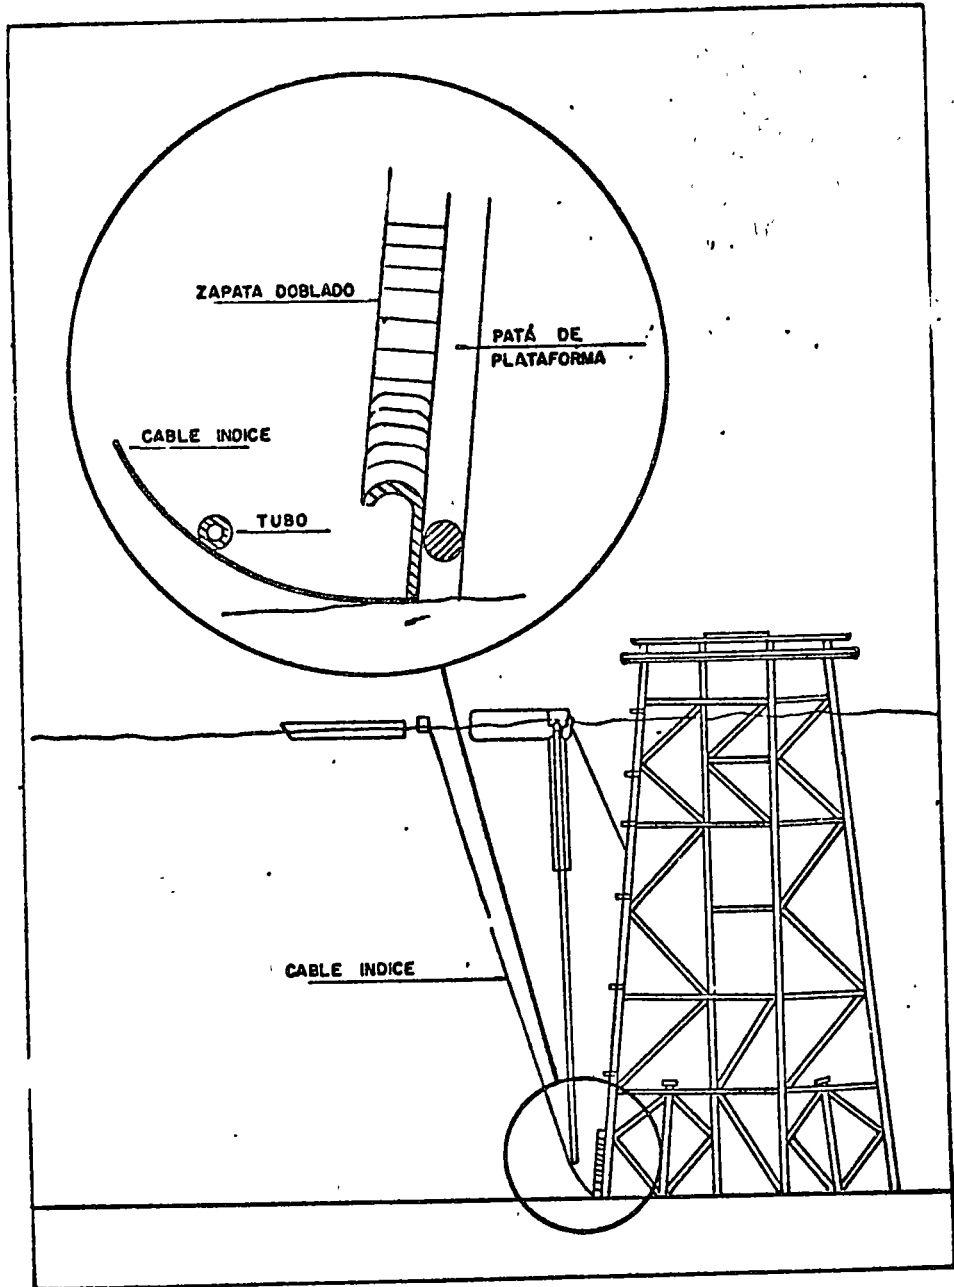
Dispositivo para colocar la tubería bajo la zapata de doblado
